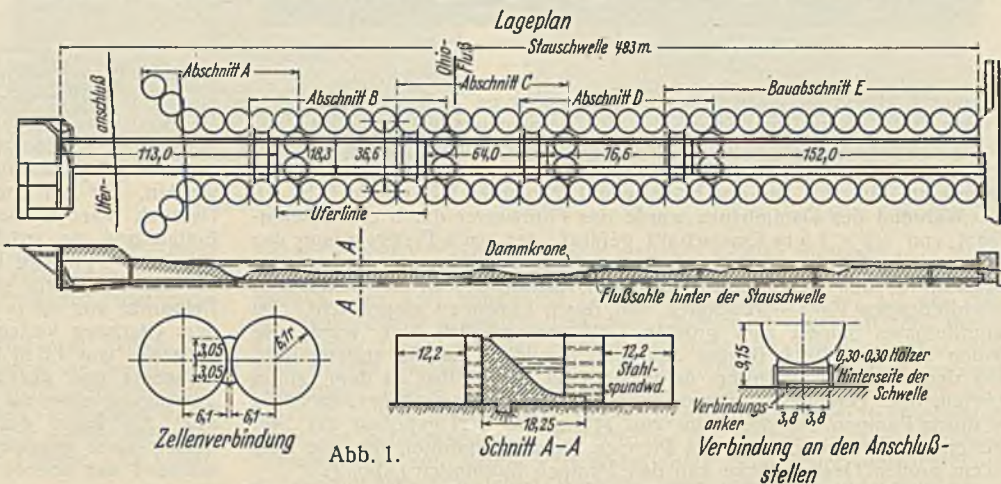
Lageplan, Längs- und Querschnitt der Stauschwelle nebst Einzelheiten des Fangedammes.
